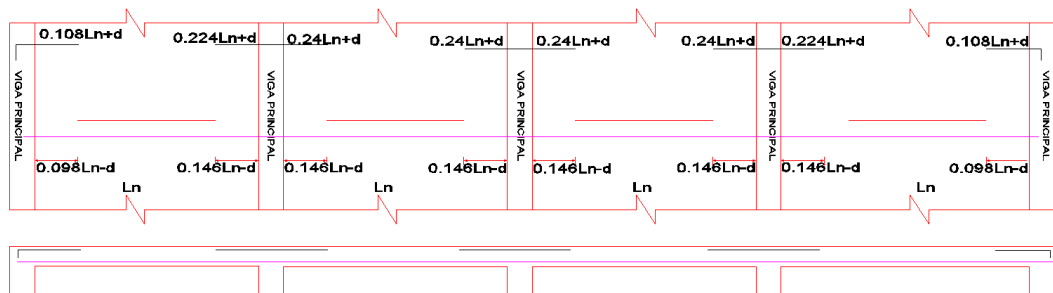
Detalle del armado de acero longitudinal de losa aligerada
